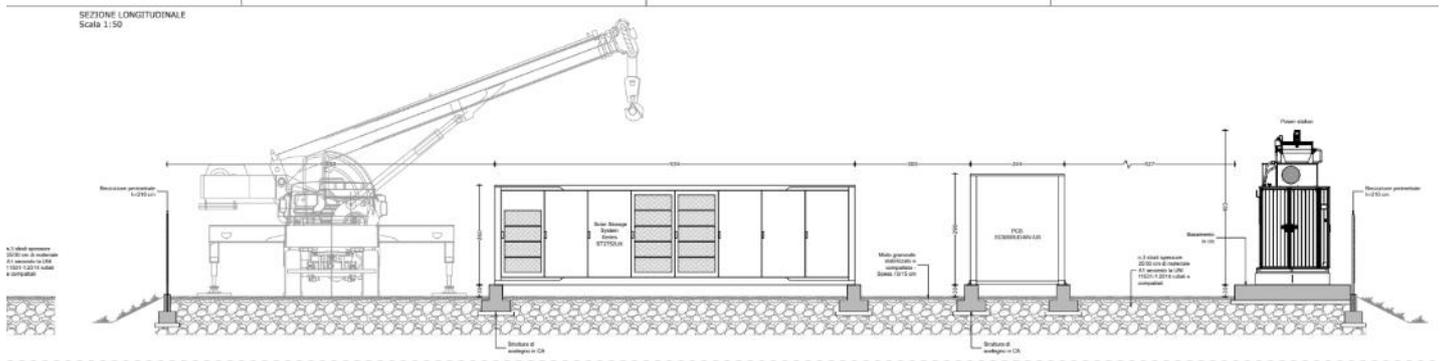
Sistema BESS: planimetria e sezione longitudinale (particolare). Sottocampo 2
